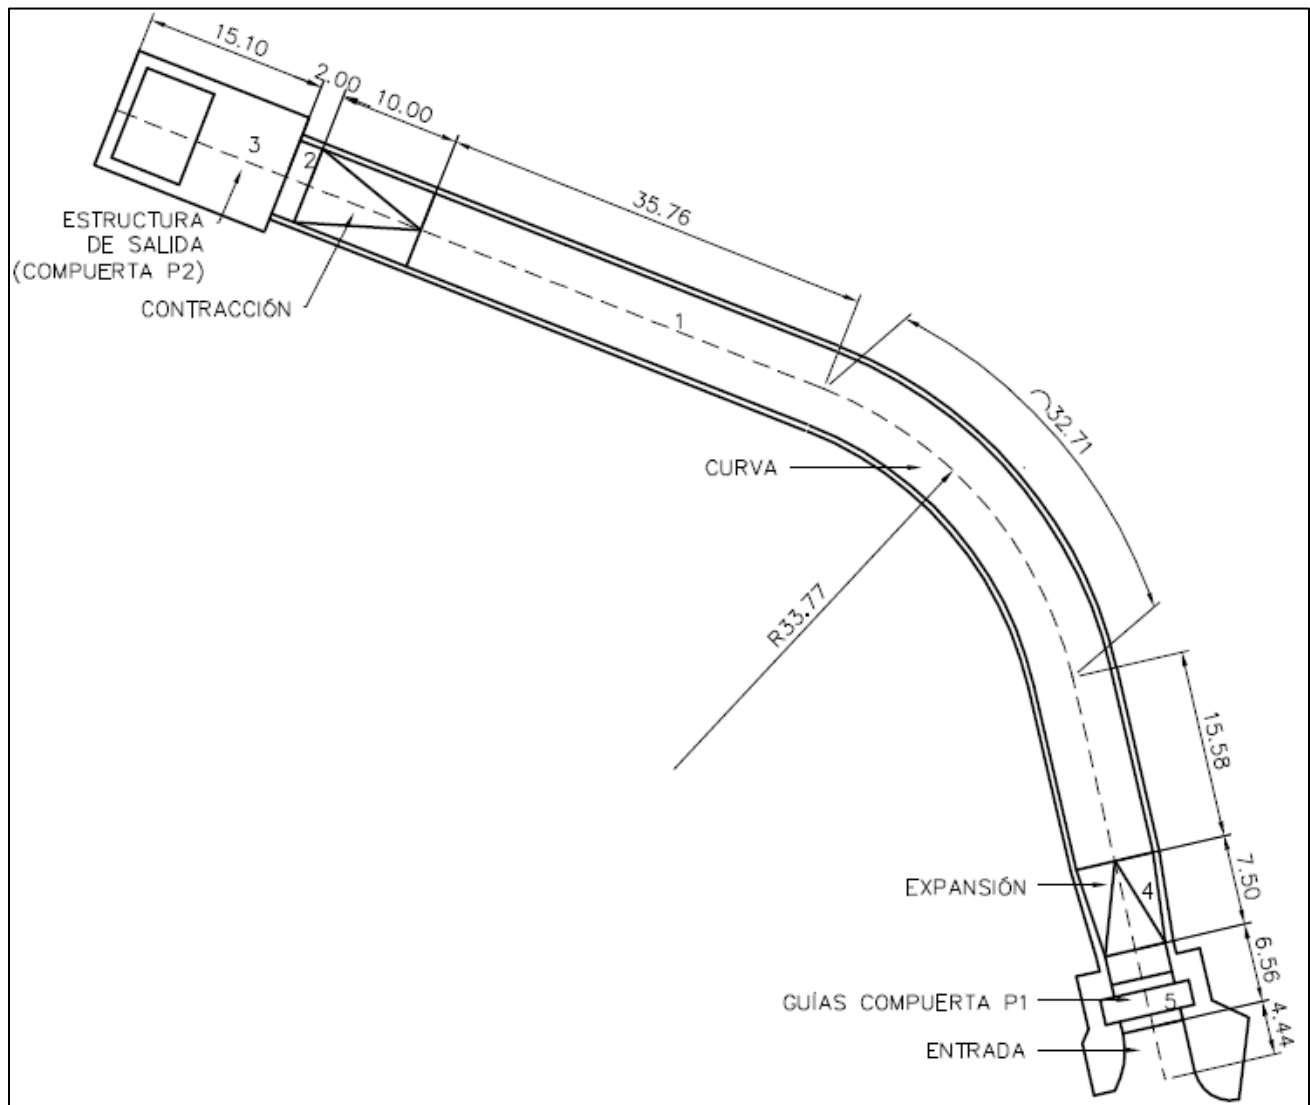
Planta general de la descarga de fondo deducida a partir de planos e informes del ICE
